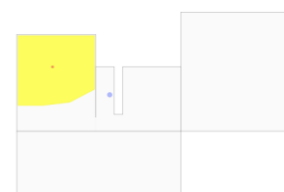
Grundriss vom 2. Obergeschoss
